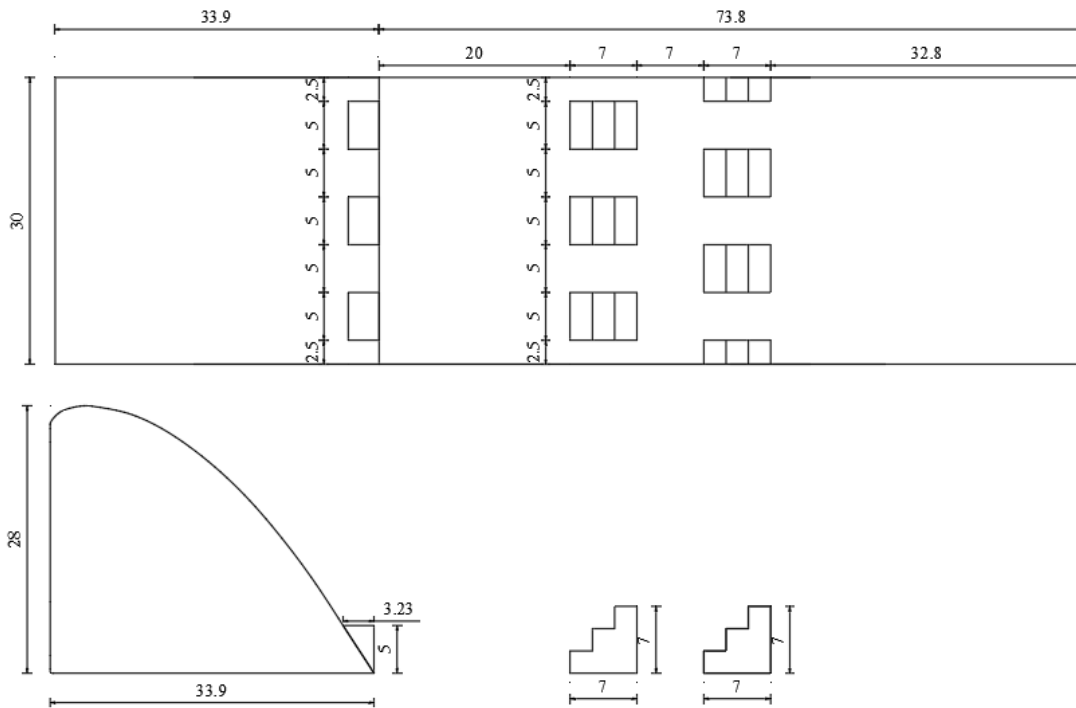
T şekilli çift sıra enerji kırıcı blokların yerleşim planı
